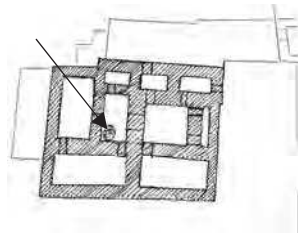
Position des Gründungsopfers im Grundriss.
